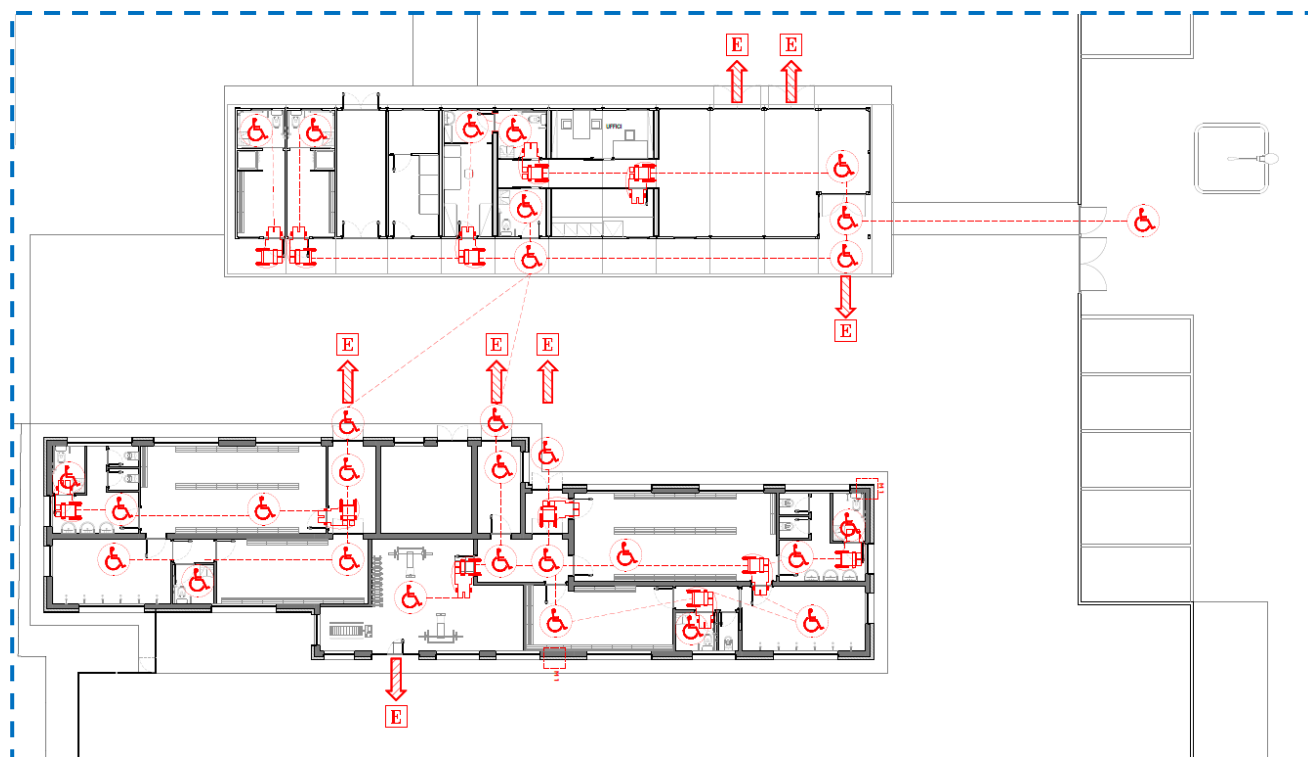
Estratto Tav.05 - Abbattimento barriere architettoniche
